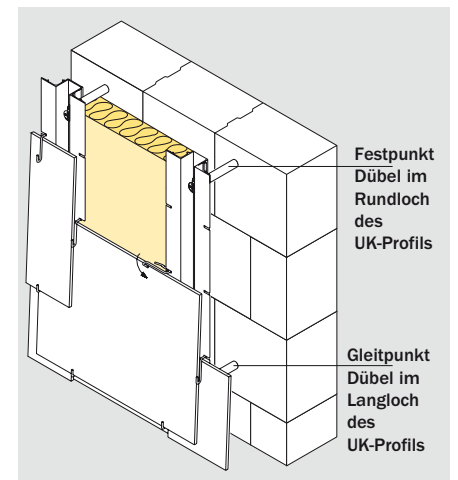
Aluminium-Unterkonstruktion mit Abstandsdübeln
